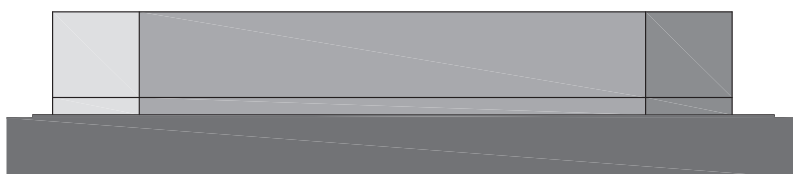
La cortina edilizia continua del Plan Cerdà secondo il progetto del 1956.
